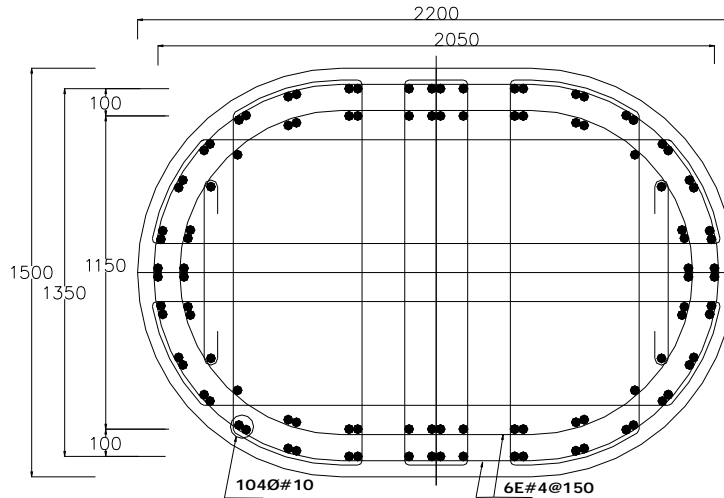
Sección de la columna prototipo (dimensiones en mm)
